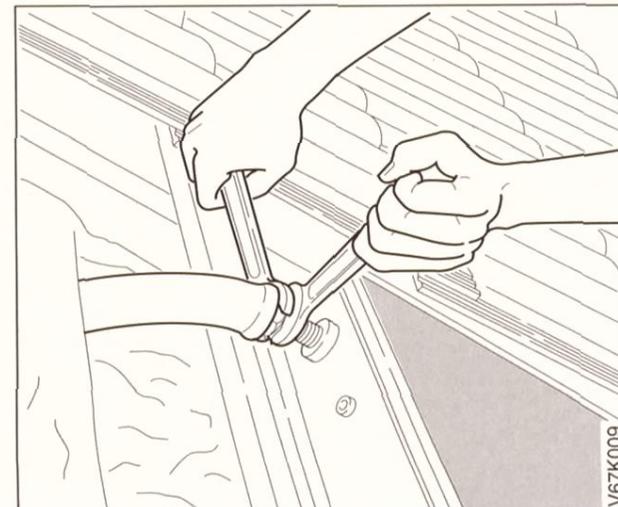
Edelstahlwellschläuche an freie Kollektoranschlüsse und unter dem Dach an Cu-Rohre des Solarkreises (mit 1/2"-18 mm Nippel) anschließen. Jetzt Verbindungen abdrücken, falls später Dachunterseite geschlossen ist.
